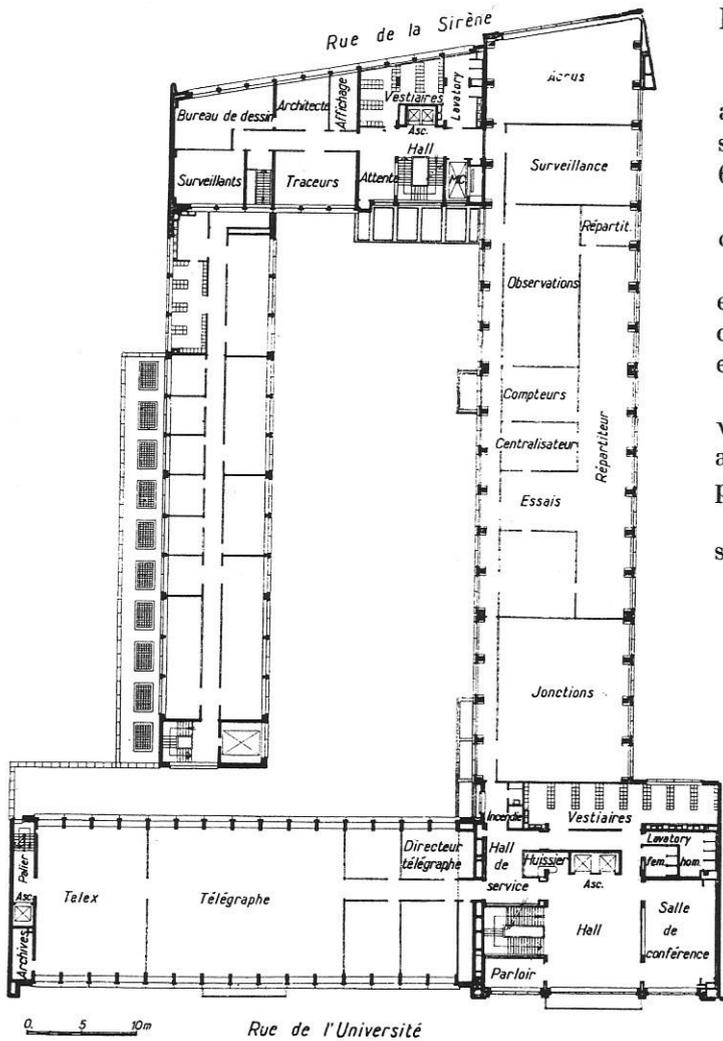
PLAN DU PREMIER ÉTAGE.
